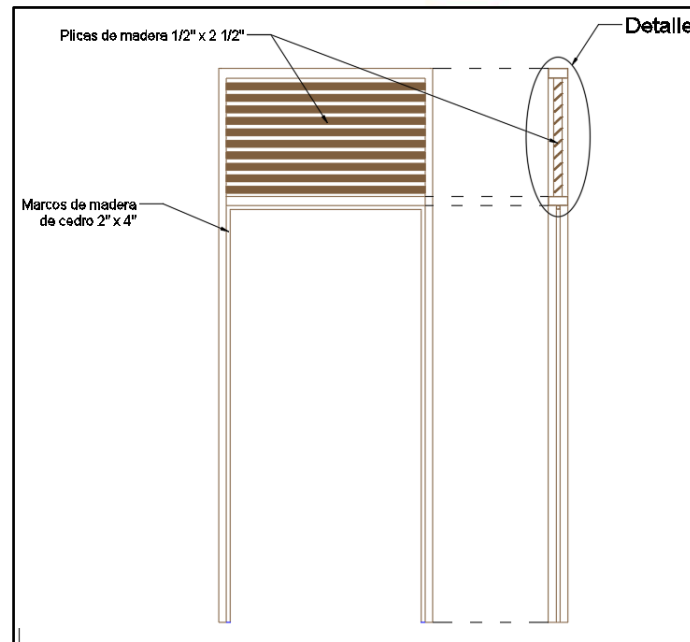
Nuevos marcos de madera a instalar (el detalle de la ventana superior está ligado a la altura de entrepiso o hasta fondo de viga de cada puerta a intervenir).
